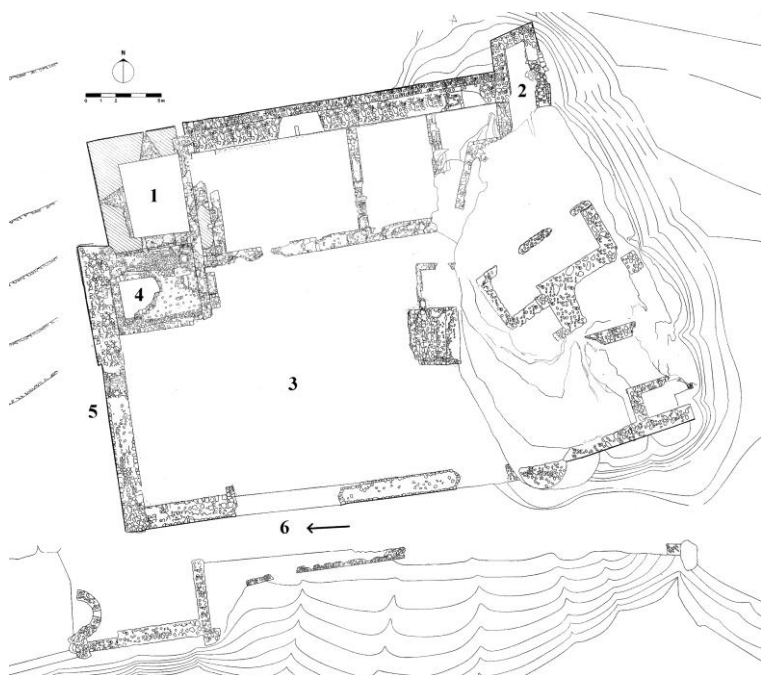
Castello della Terravecchia di Caltavuturo: planimetria generale dopo i primi interventi (da VASSALLO 2009)
